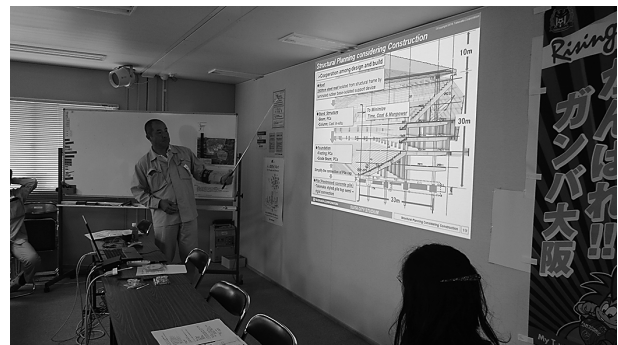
(仮称)吹田市立スタジアムの施工方法の説明
